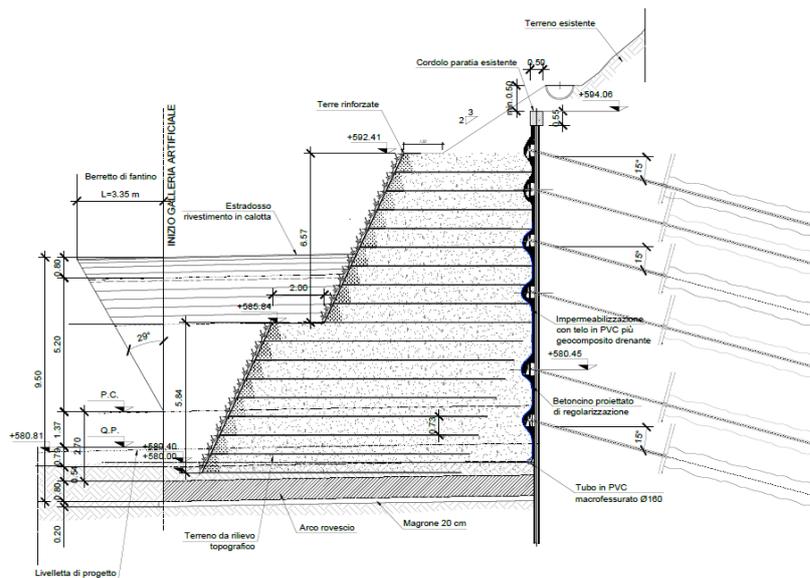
Galleria Guinza - Imbocco lato Umbria – Terre armate – Sezione trasversale
